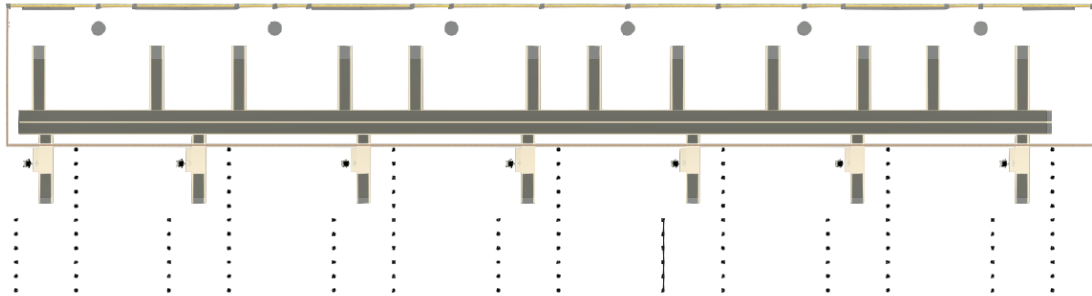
Vista de planta de la zona de tratamiento de equipaje del vestíbulo principal.
